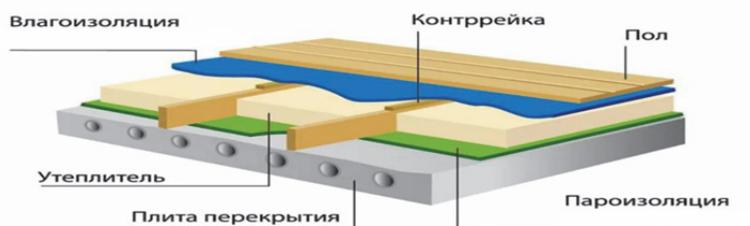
Применение пароизоляционной пленки в устройстве плиты перекрытия
